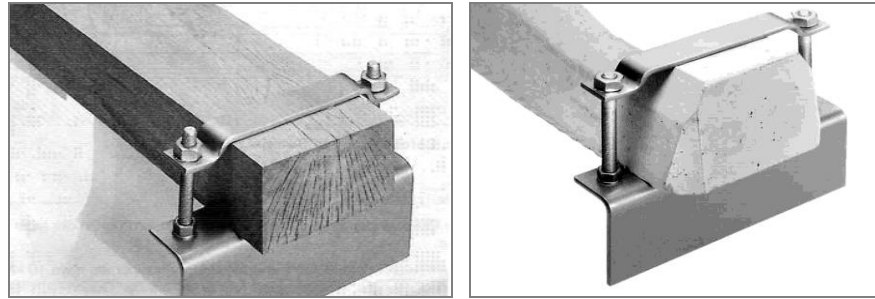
Вигляд дерев'яних та залізобетонних шпали із анкерами на торцях
